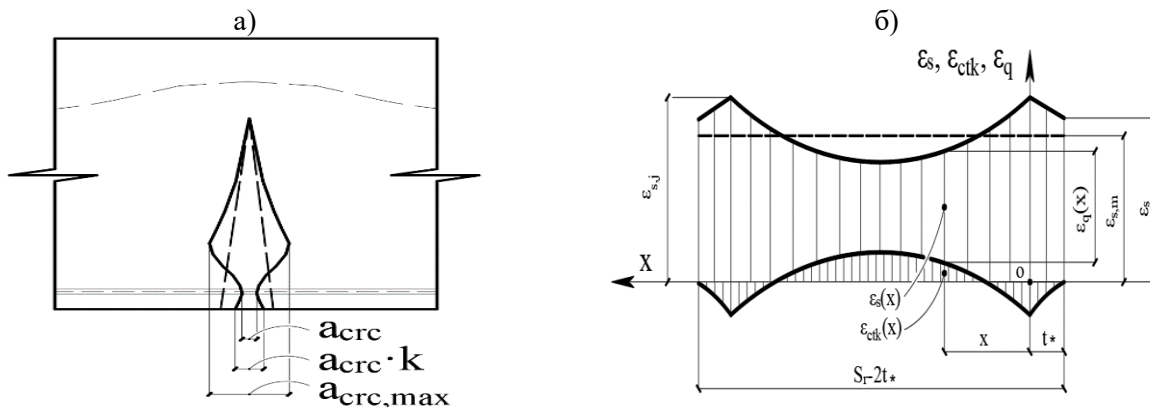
Деформационный эффект железобетона: форма трещины, трансформирующаяся от треугольника до эллипсоида (а); и реакция от несплошного бетона до сплошной арматуры; (б)-относительные деформации арматуры и растянутого бетона по оси x
